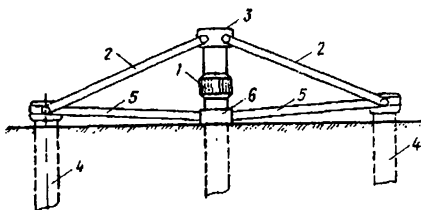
Безбалочная установка для испытаний эталонных свай конструкции ГПИ «Фундаментпроект»
